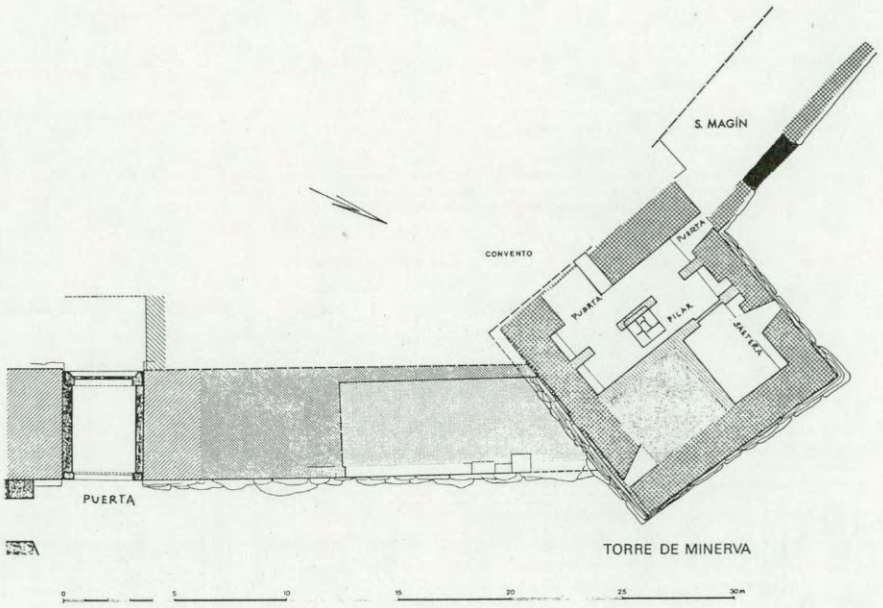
Tarragona, muralla. Planta de la Torre de Minerva y de la puerta romana.
